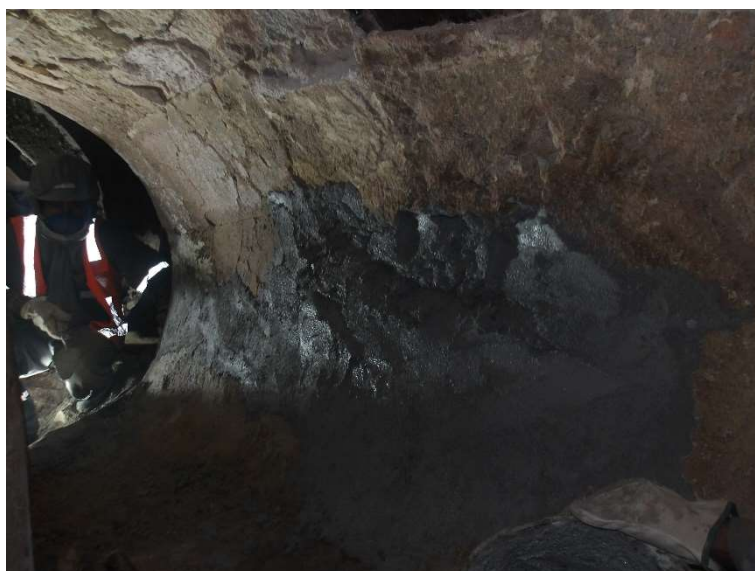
Aplicação de concreto para recuperação do revestimento refratário.
